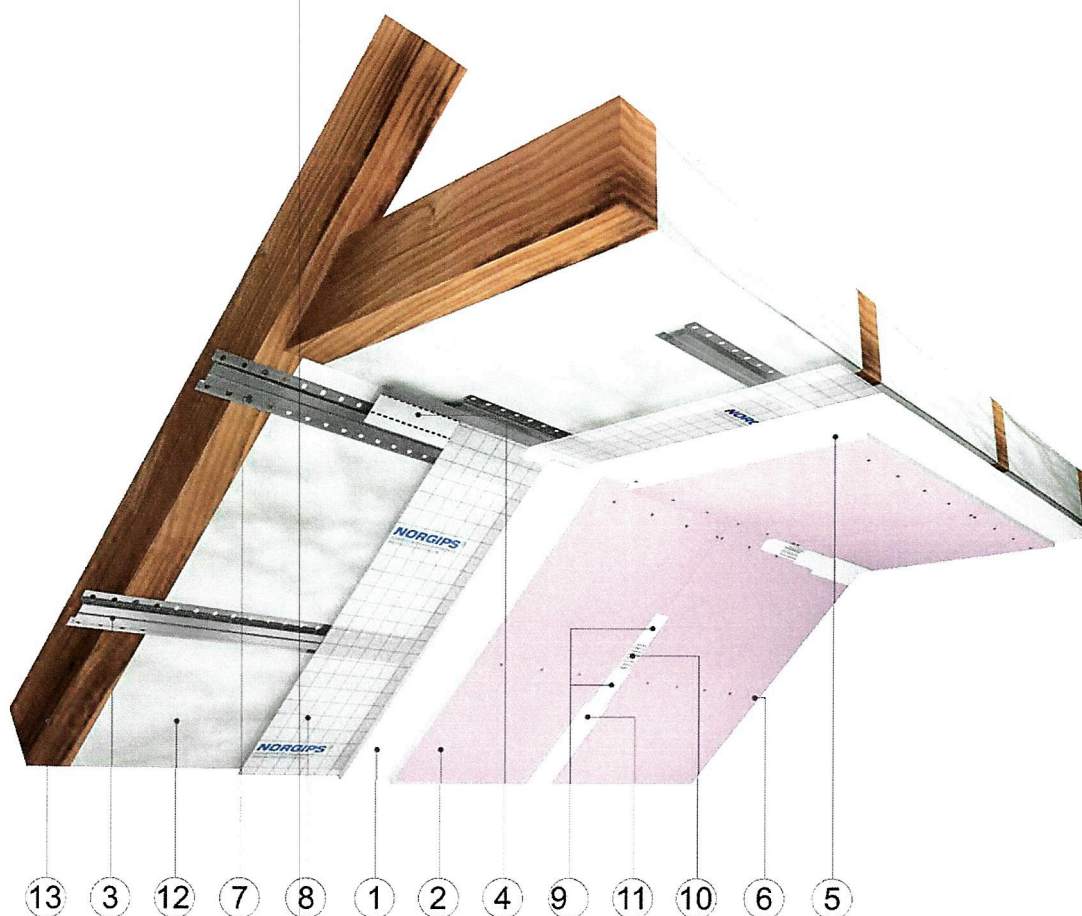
Widok zabudowy dachu na konstrukcji z profili CD 60 i wieszakach ES lub ES plus z wypełnieniem pianą PUR
